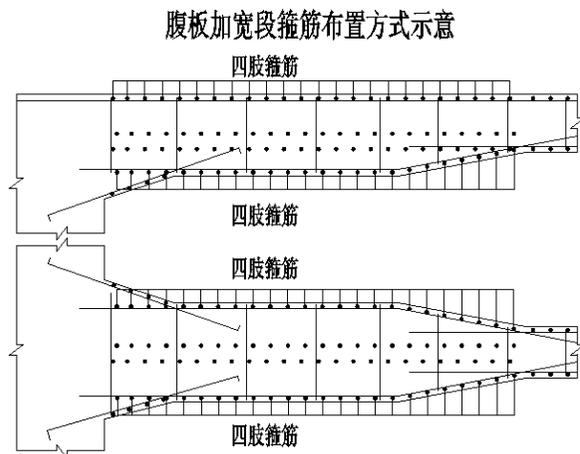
箱梁钢筋-腹板加宽段箍筋布置方式-四肢箍筋
